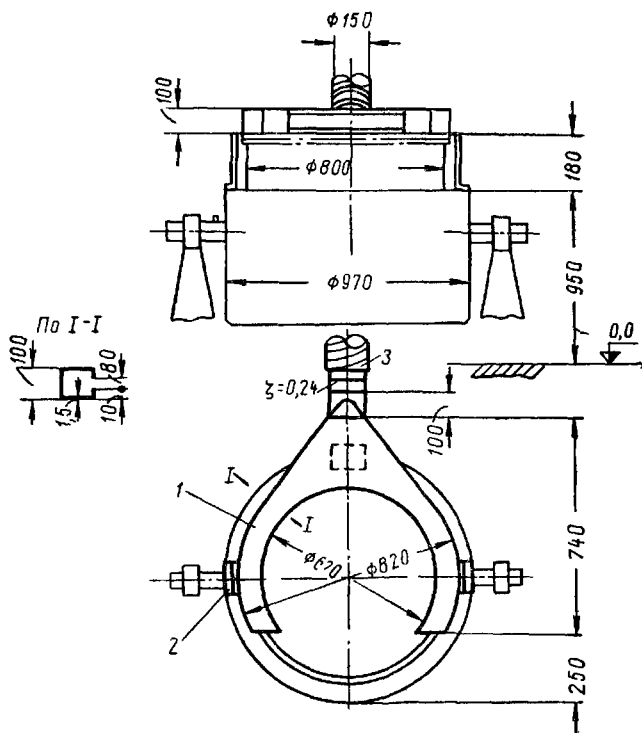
Бортовой отсос от клеварочного котла с ручным перемешиванием
